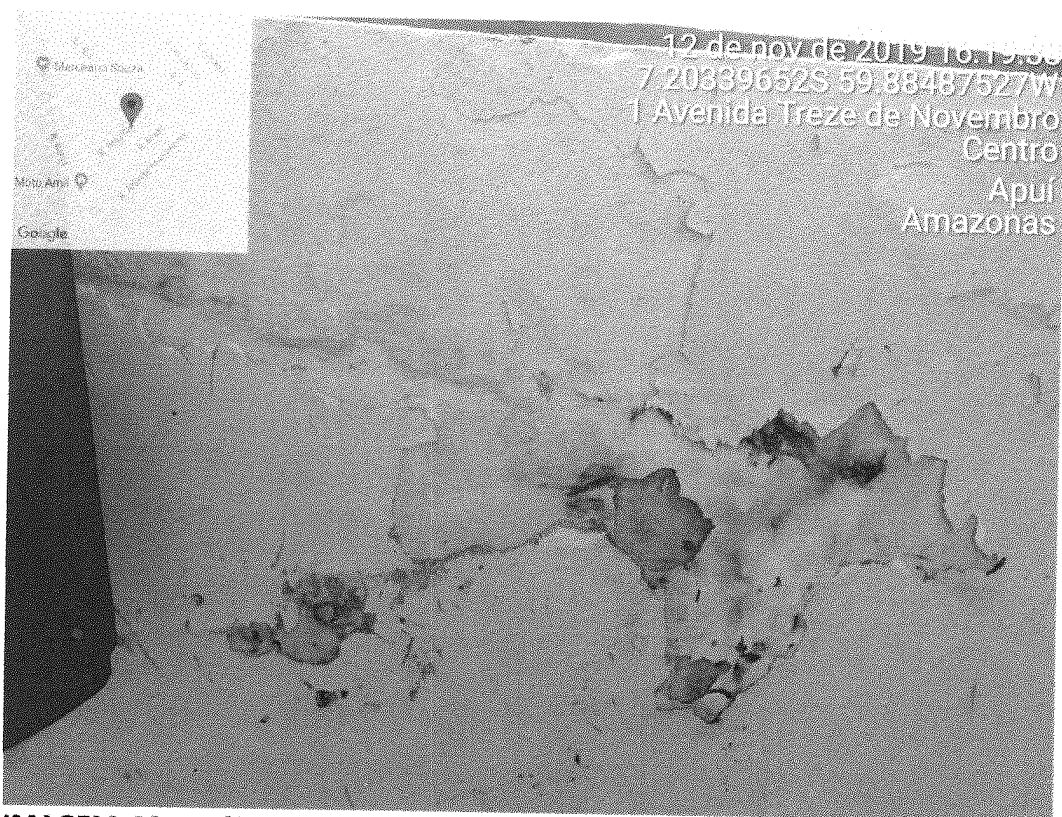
Infiltrações de água por capilaridade pela ausência do sistema de impermeabilização da fundação (VIGA BALDRAME);
